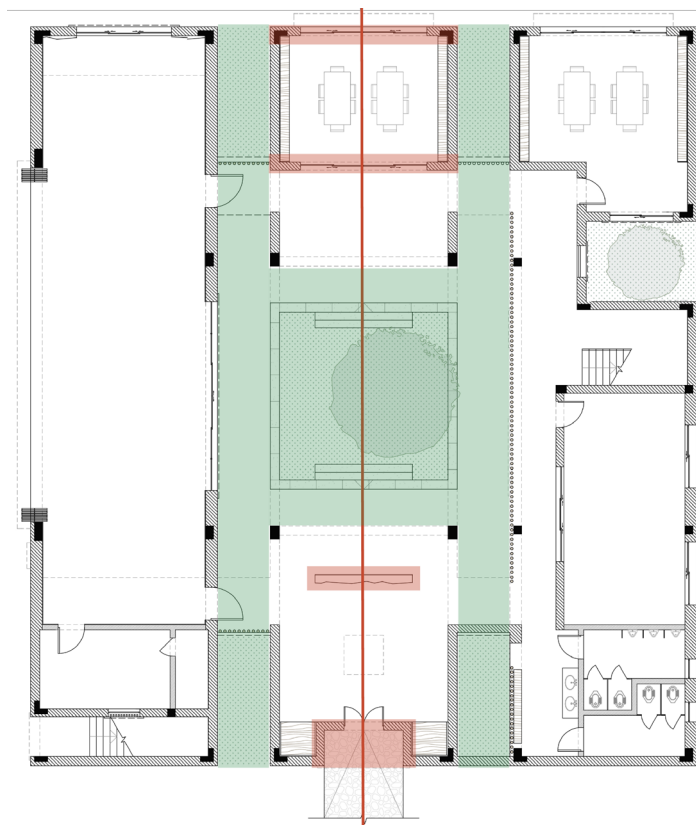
Planta do rés-do-chão da fase final do projecto do Centro Cultural de Zishi.
